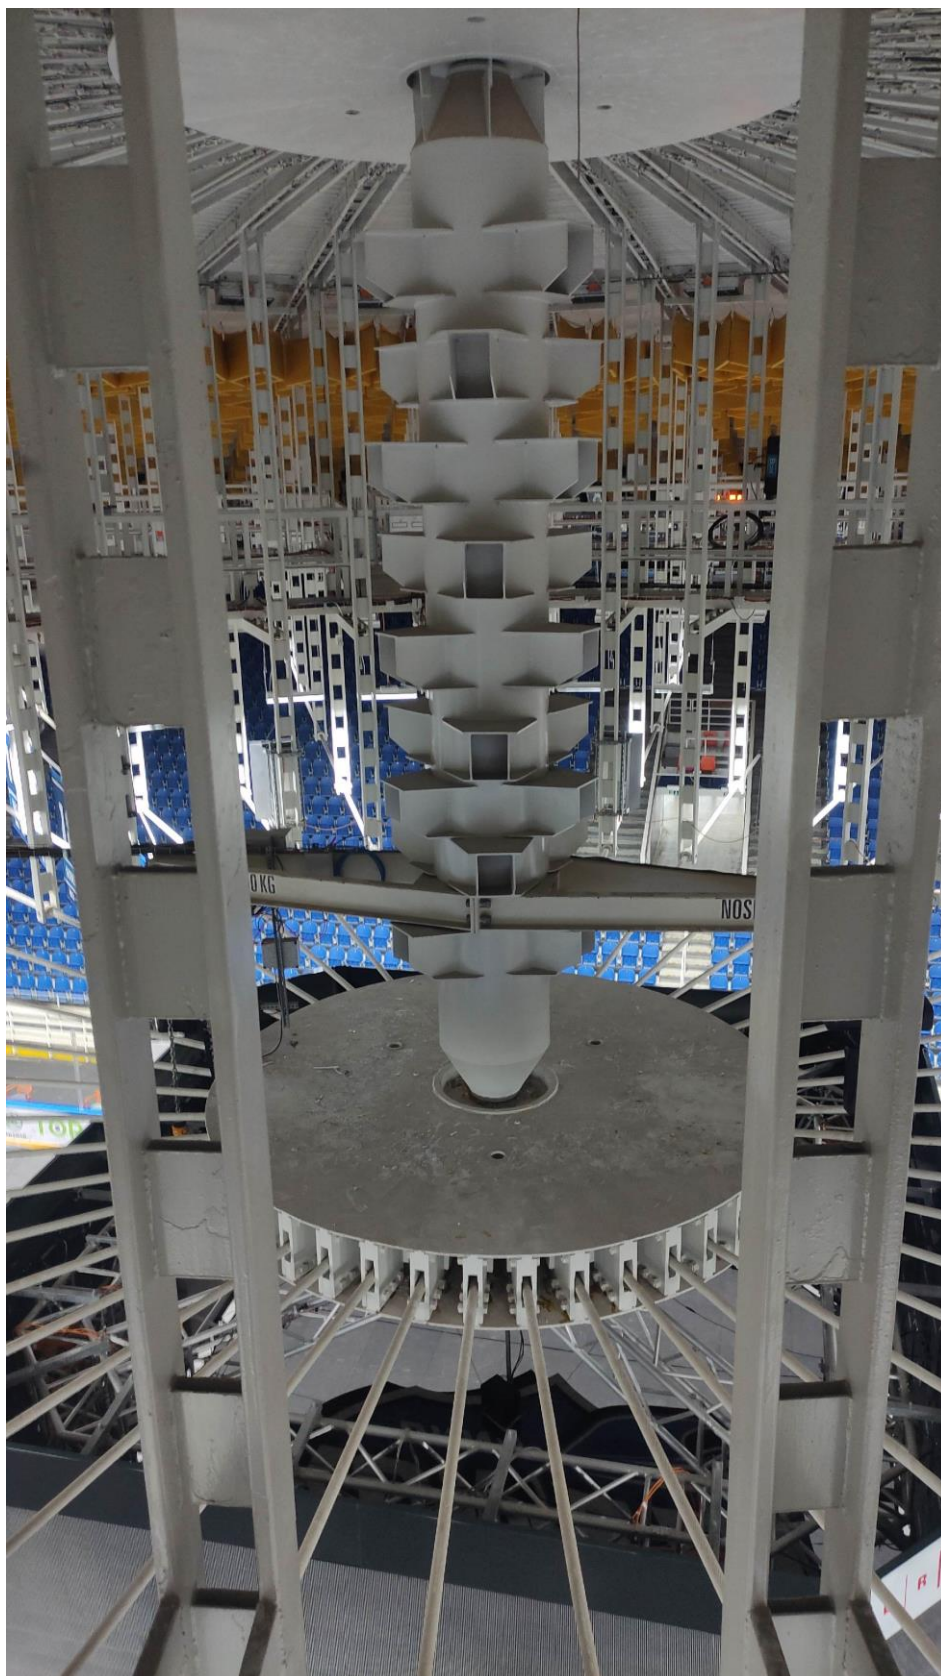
Detailní pohled na rozpínací vřeteno a kotevní prstence horních a dolních lan
